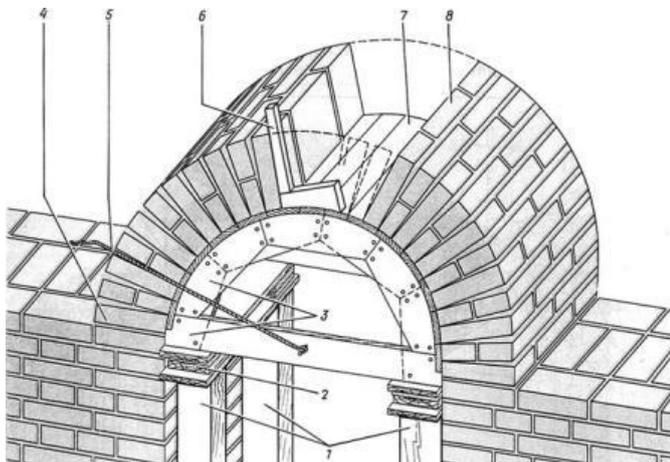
Кладка арочной перемычки: 1 – стойки, поддерживающие опалубку; 2 – клинья; 3 – кружальная опалубка; 4 – пята арки; 5 – шнур; 6 – шаблон-угольник; 7 – дощатая обшивка; 8 – ряды кладки, образующие перемычку
